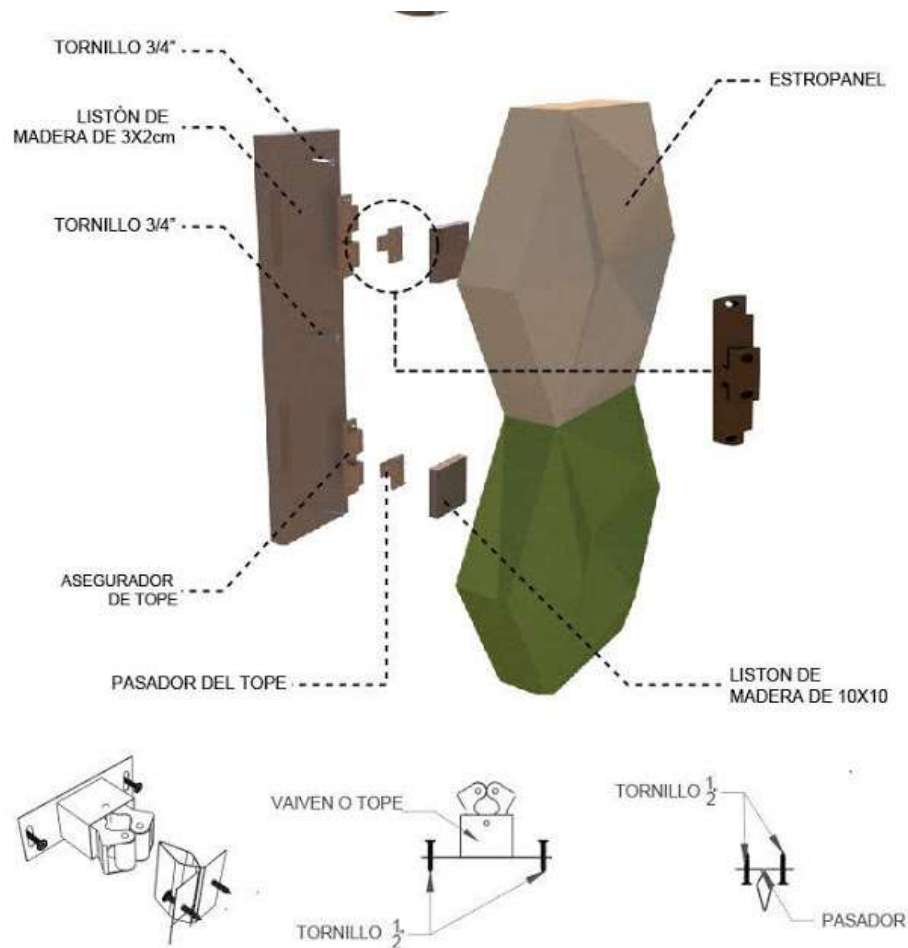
Detalle del sistema de instalación de soporte tipo clic individual
